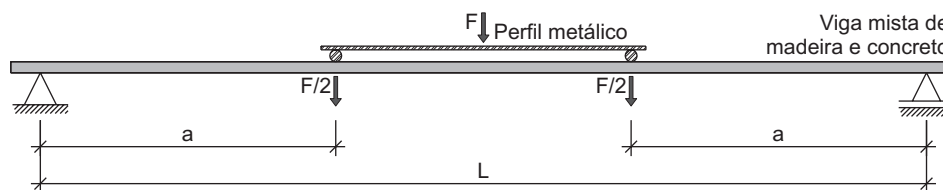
Esquema estrutural de ensaio das vigas mistas de madeira e concreto.
